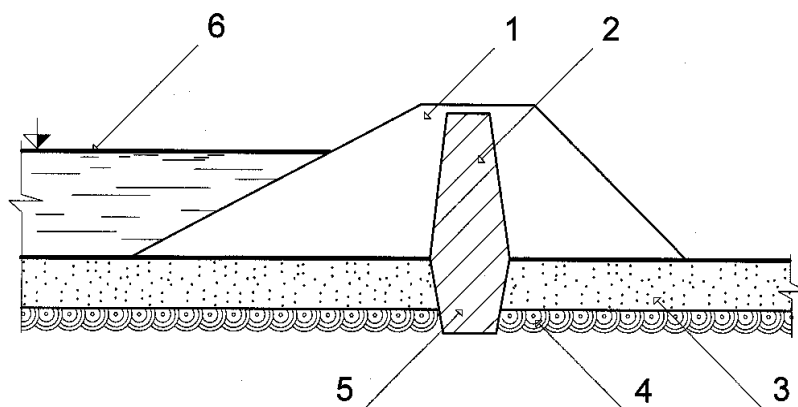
Схема грунтовой перемычки с ядром: 1 – перемычка; 2 – ядро; 3 – водопроницаемый слой грунта; 4 – водоупор; 5 – замок; 6 – горизонт воды
